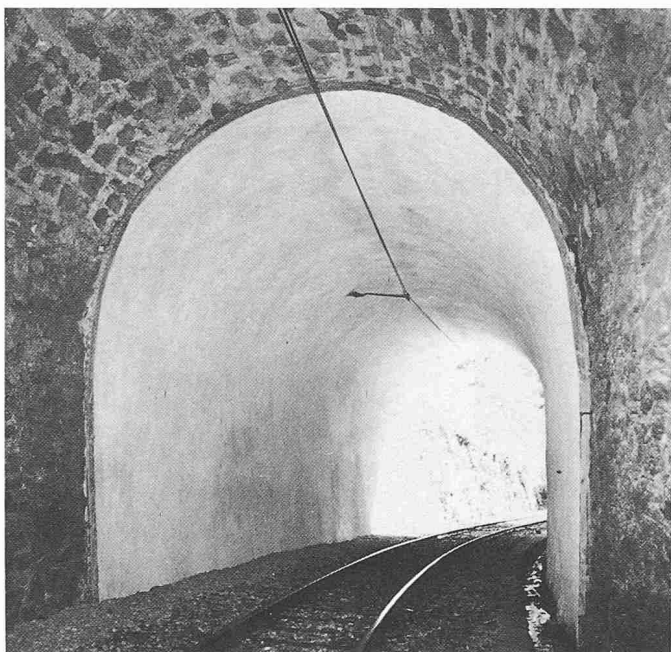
Mit Spritzbeton beschichtetes Tunnelgewölbe. Abdichtung
